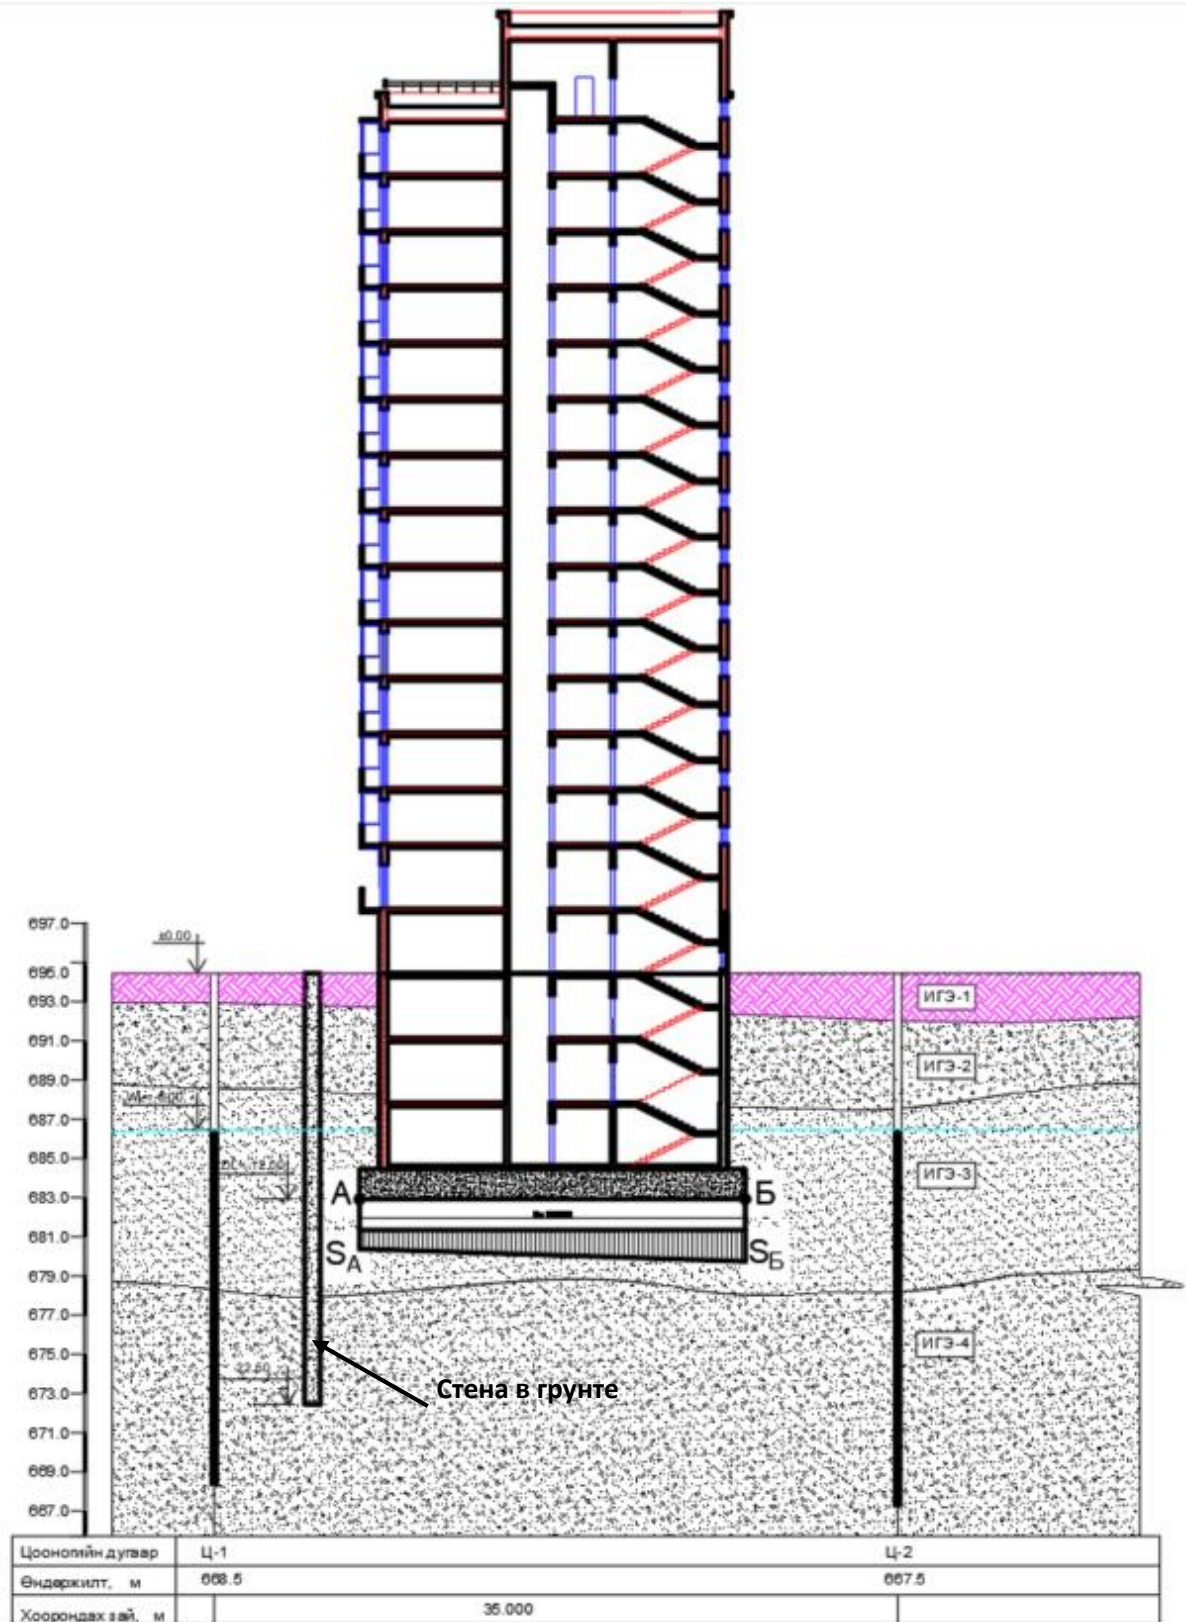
Поперечный разрез здания и геологическое строение строительной площадки
